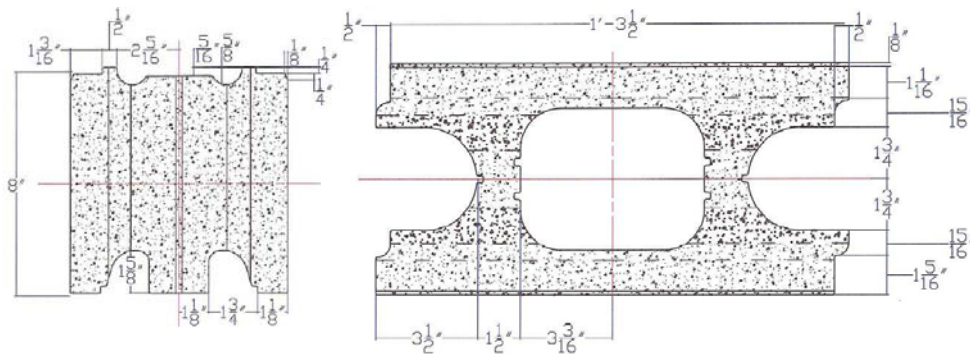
Detalle de la pieza Azar block. Alzado lateral [izquierda] y planta [derecha].
